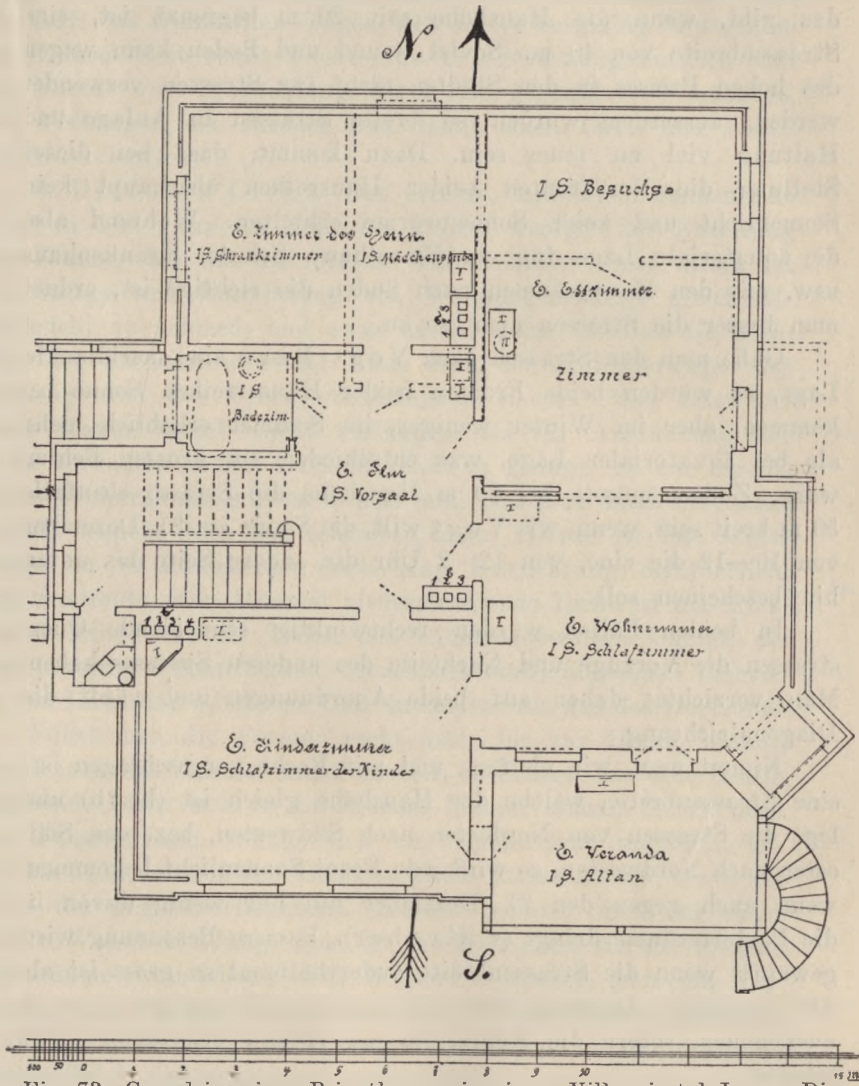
Grundriss eines Privathauses in einem Villenviertel Jenas. Die mit E bezeichneten Räume liegen im Erdgeschoss (Hochparterre), die mit IS bezeichneten und die gestrichelten Zimmerumgrenzungen und Türen im Obergeschoss. a 1 Schornstein der Lokalheizung der Gastzimmer. a 2 Schornstein der Zentralheizung. a 3 Ventilations-schacht f. d. Herrenzimmer. b 1 Ventilationsschlot f. d. Kinderschlafzimmer. b 2 Ventilationsschlot für das Wohnzimmer. b 3 Ventilationsschlot für das Schlafzimmer. c 1 Ventilationsschlot für das Abfallrohr und die Tonne. c 2 Kitchenschornstein. c 3 Ventilationsrohr f. d. Schwadenfang der Küche. c 4 Ventilationsrohr für das Kinderzimmer. I Heizkörper (Bechem u. Post). II Füllöfen.
